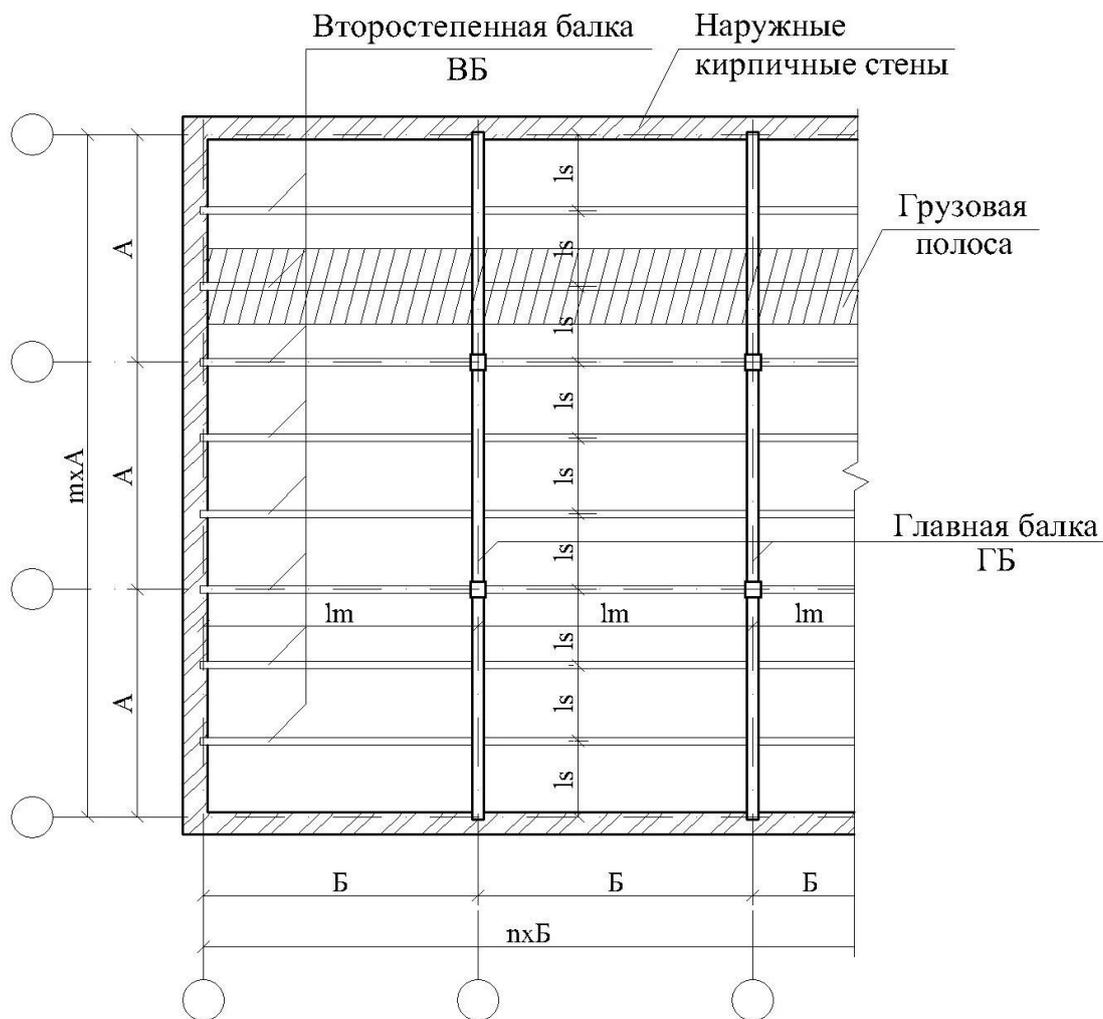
Схема здания с монолитным перекрытием к расчету второстепенной балки
